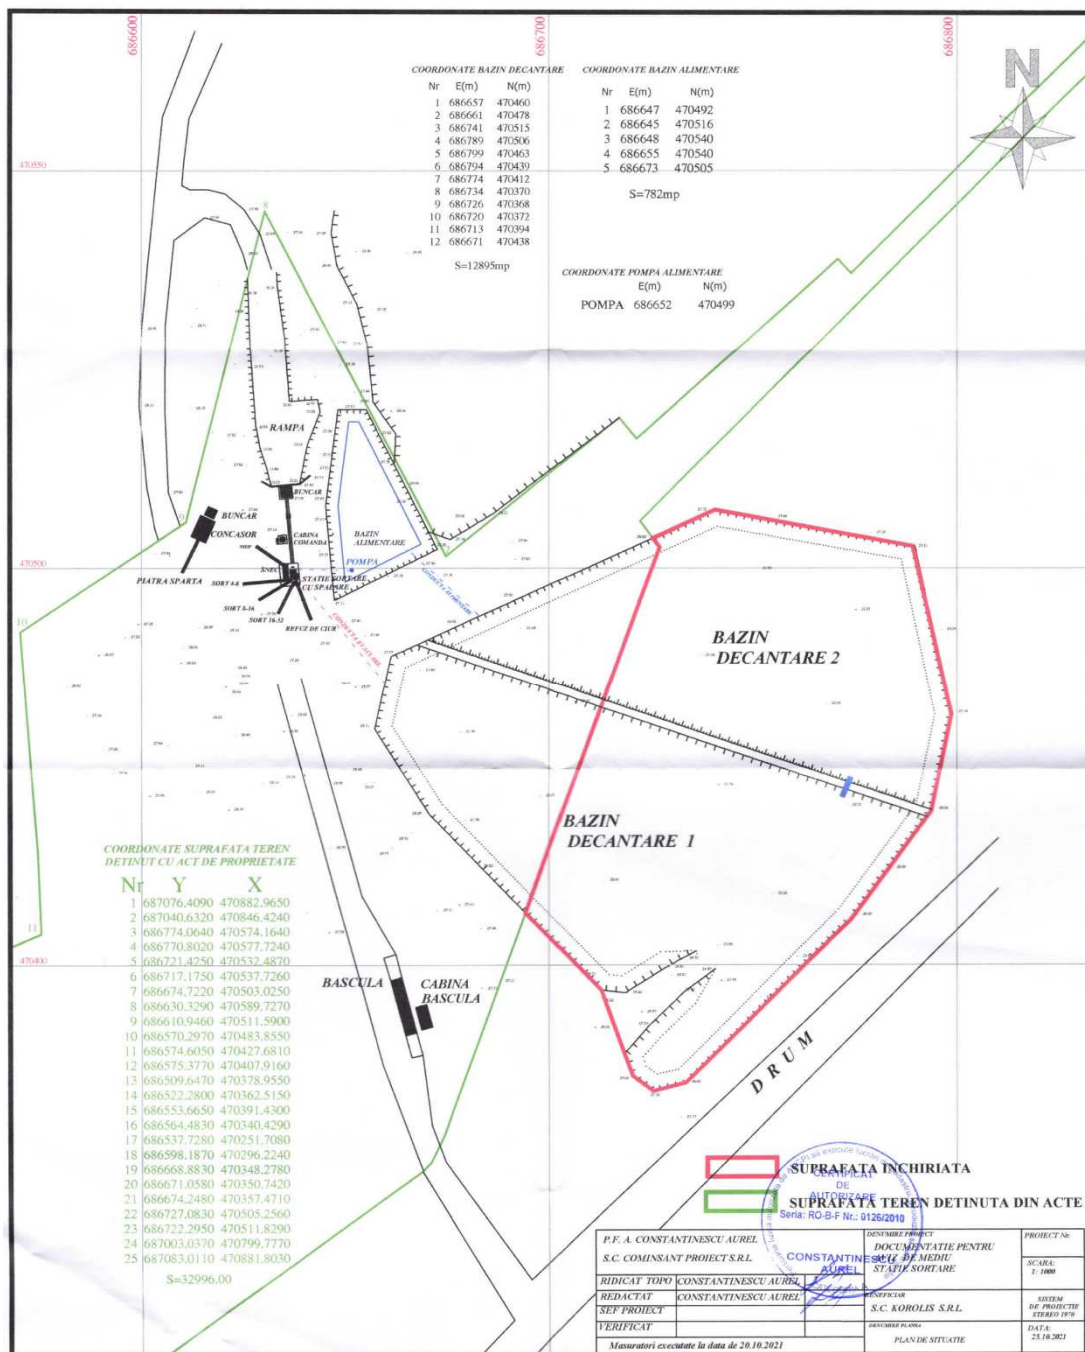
Plan de situație – Perimetrul Umbrărești T24
